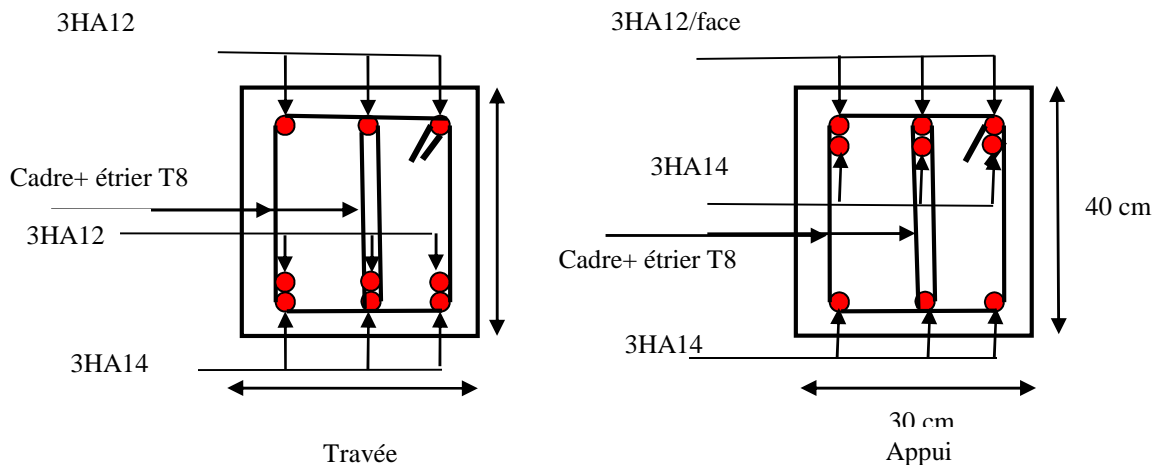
Schéma de ferrailage de la poutre principale de la terrasse inaccessible
